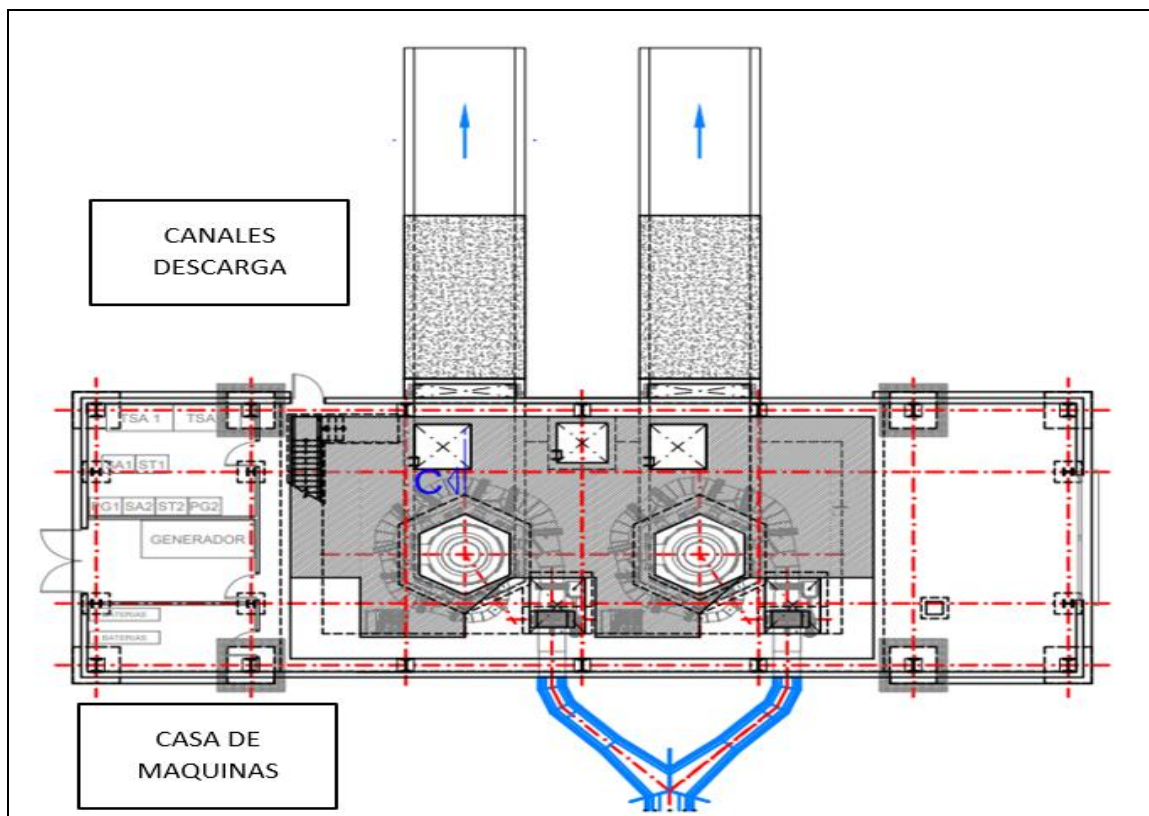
Vista en planta de casa de máquinas C.H. El Carmen.
